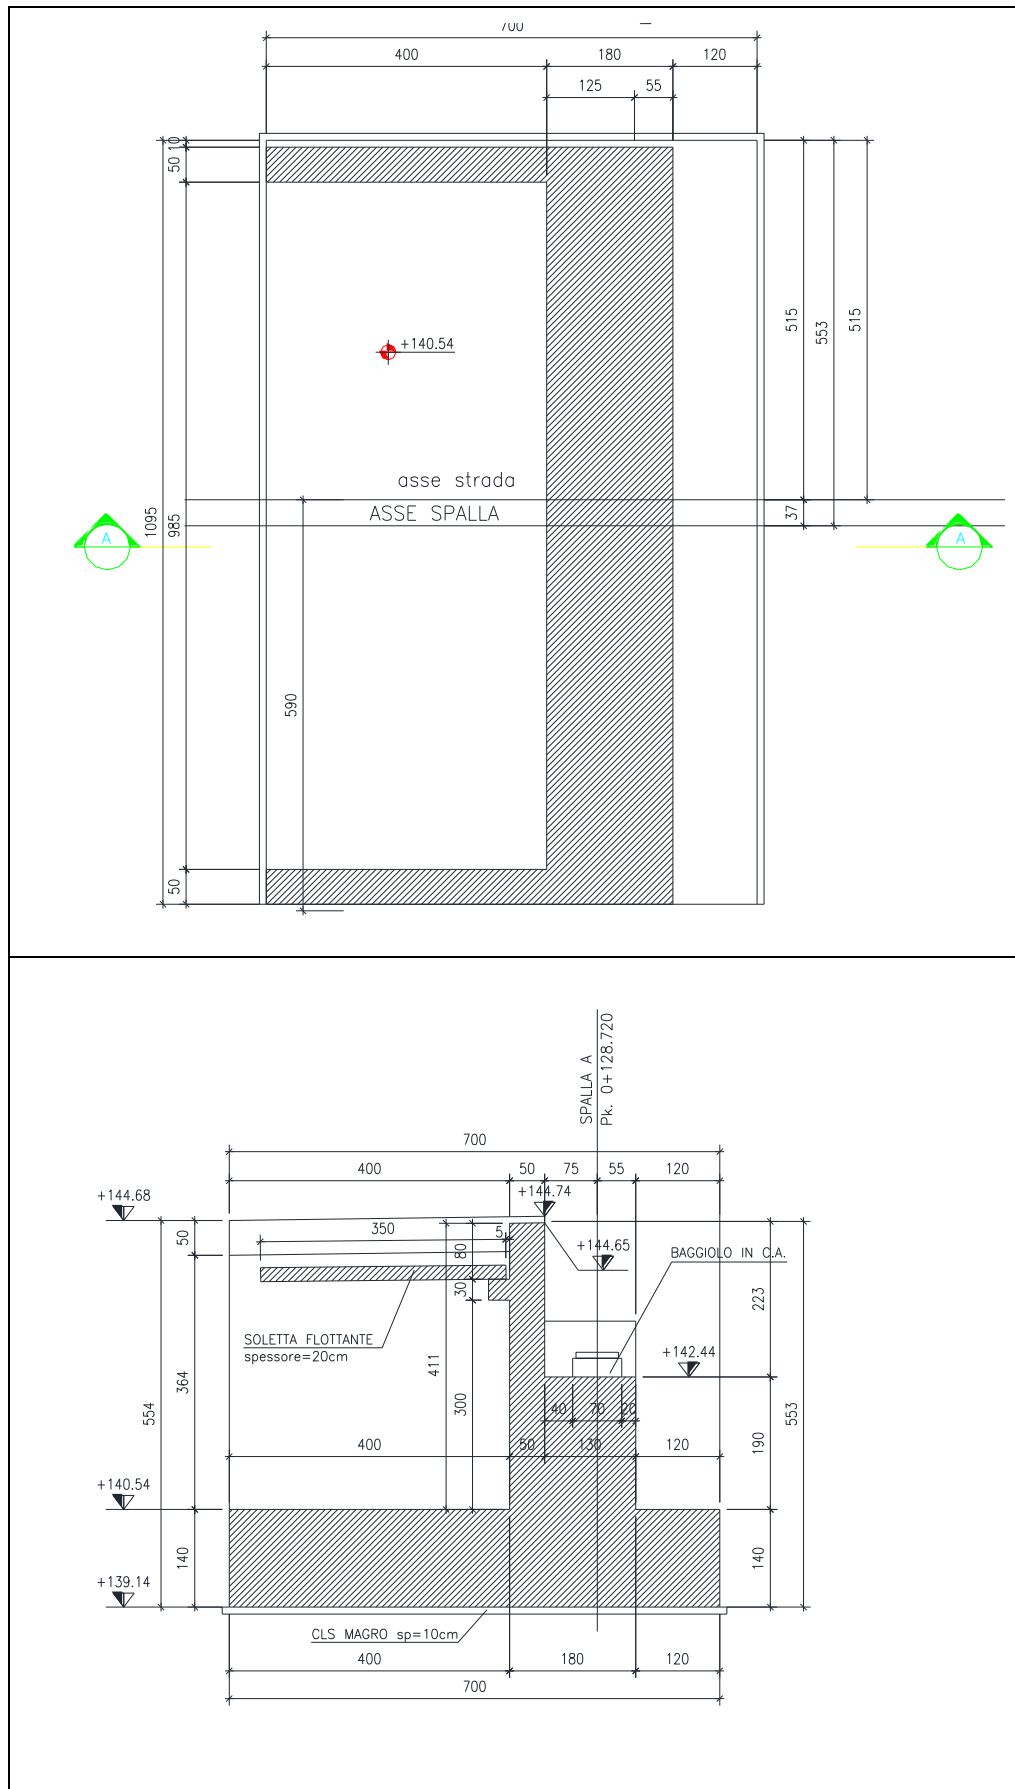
Spalla "A"- Pianta e Sezione
